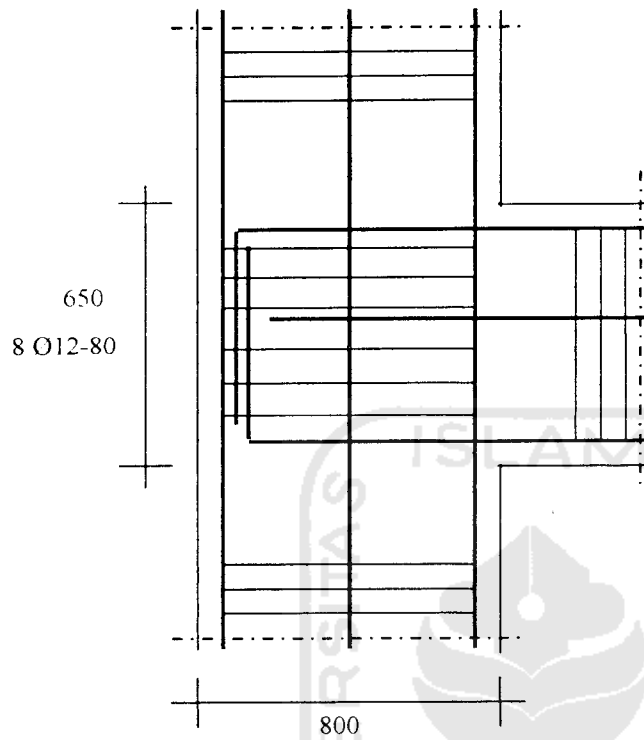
Detail join Balok Kolom D Lantai 10 dan 11
